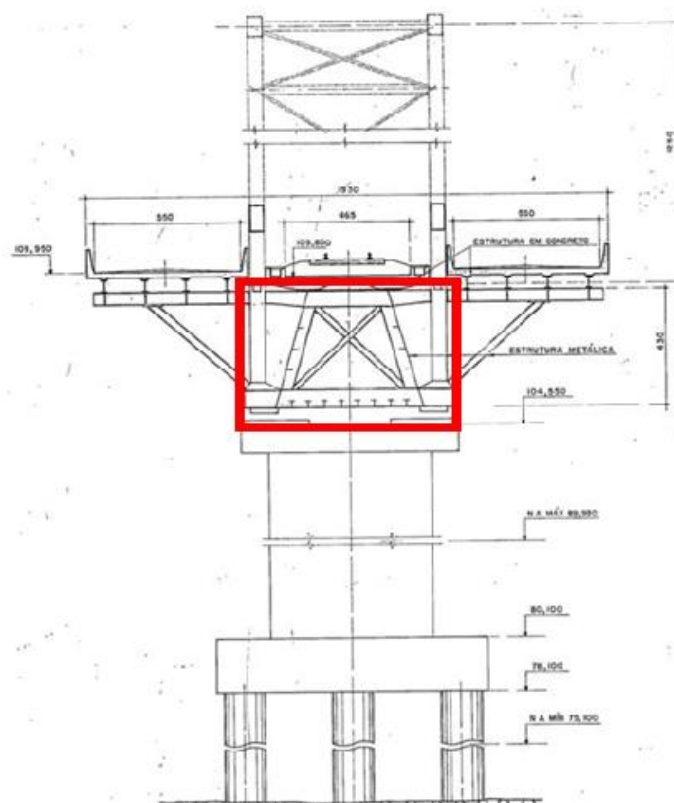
Corte transversal da estrutura da ponte com indicação da área da superestrutura, objeto de reforço.
